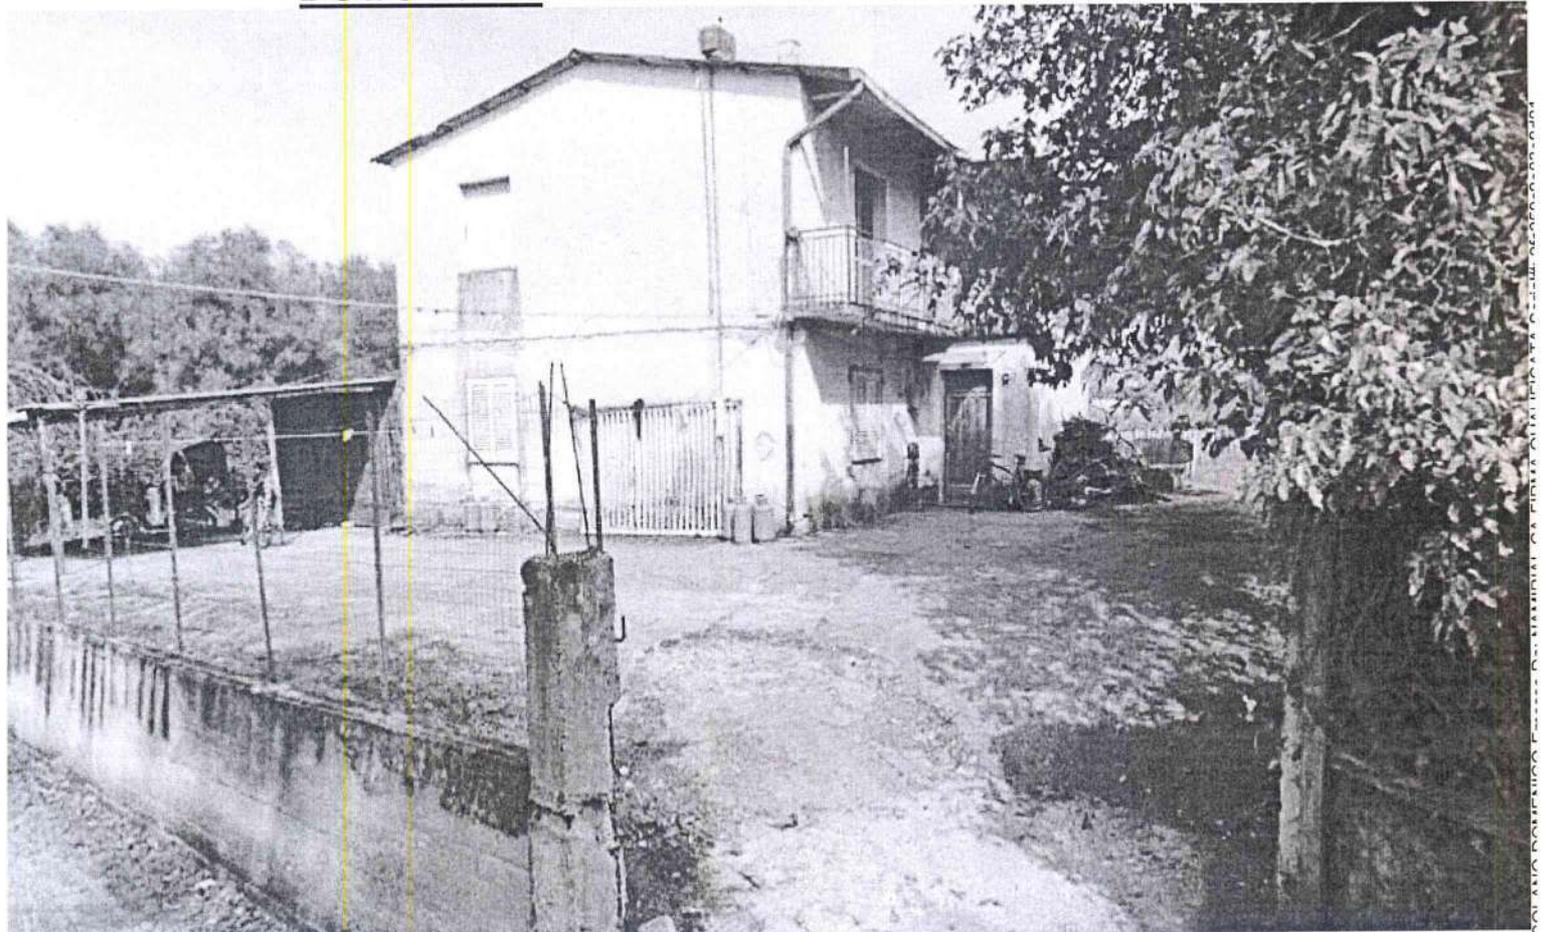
Il fabbricato visto dall’accesso sulla Strada Sant’Antonio
